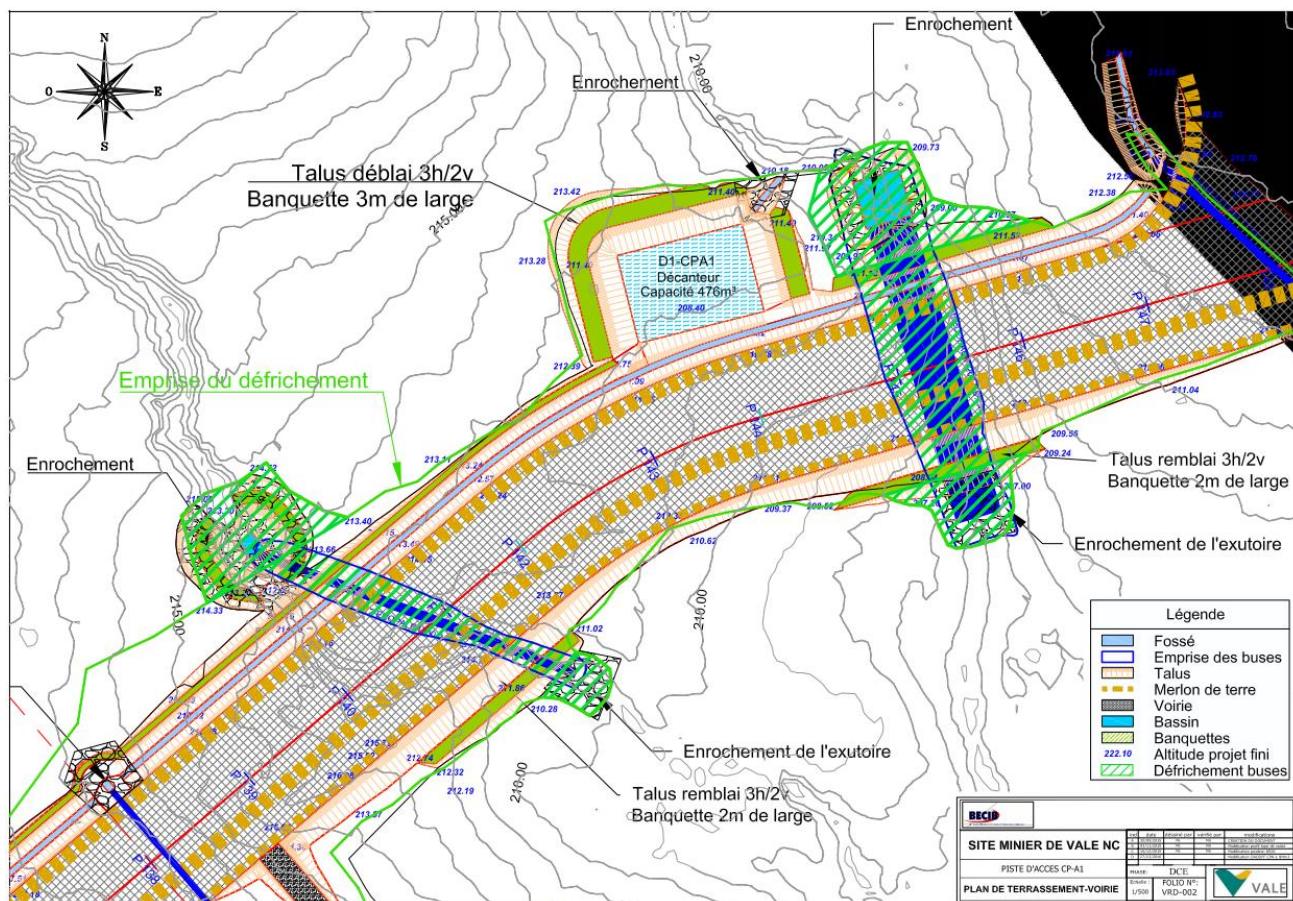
Surface défrichée pour l'installation des radiers (fond de plan VNC)
